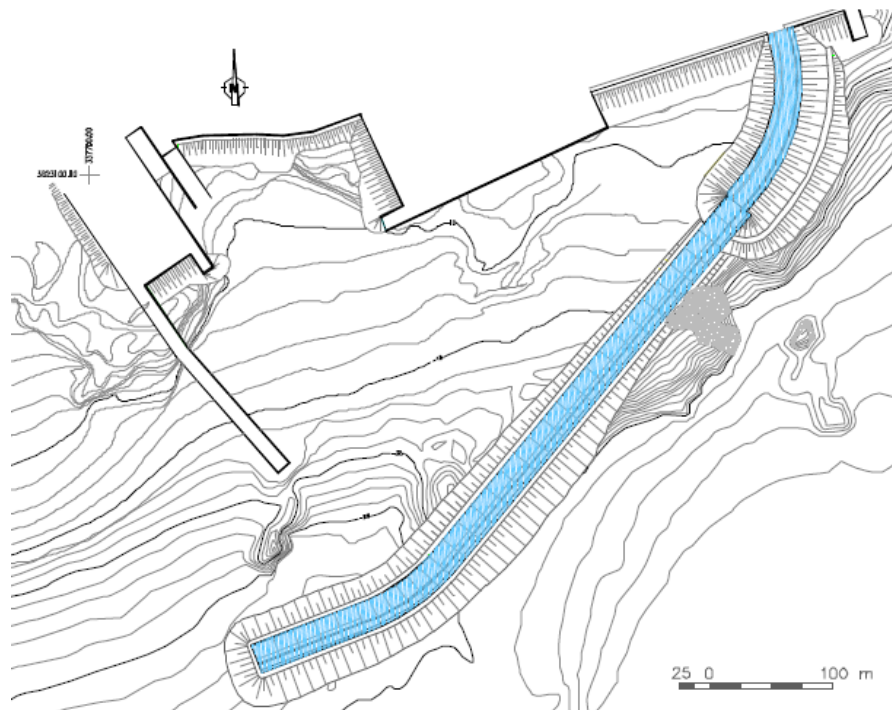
Planta geral do Porto do Caniçal. [2]
